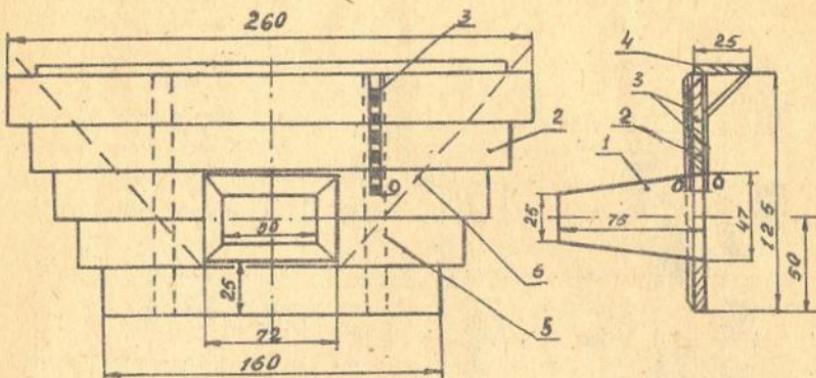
Водомерный насадок ВН-10х20: 1 - насадок;
